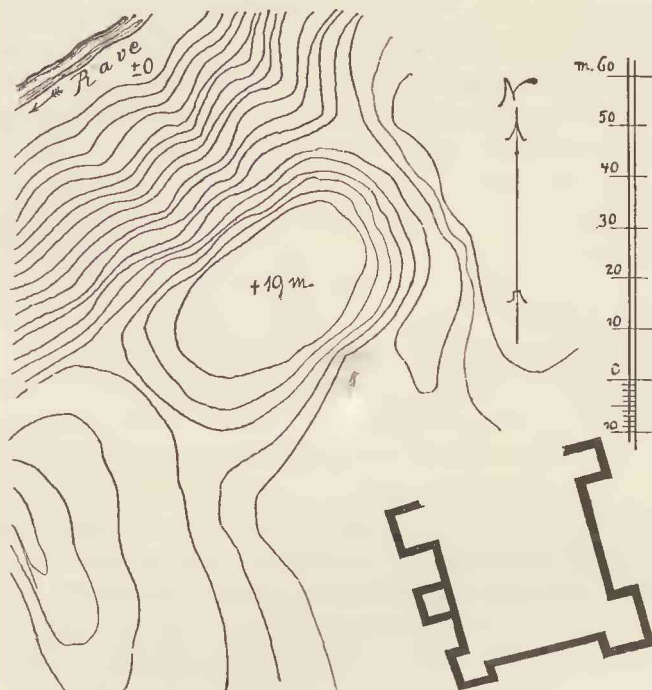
Lageplan des Fliehhauses bei Lamgarben.
